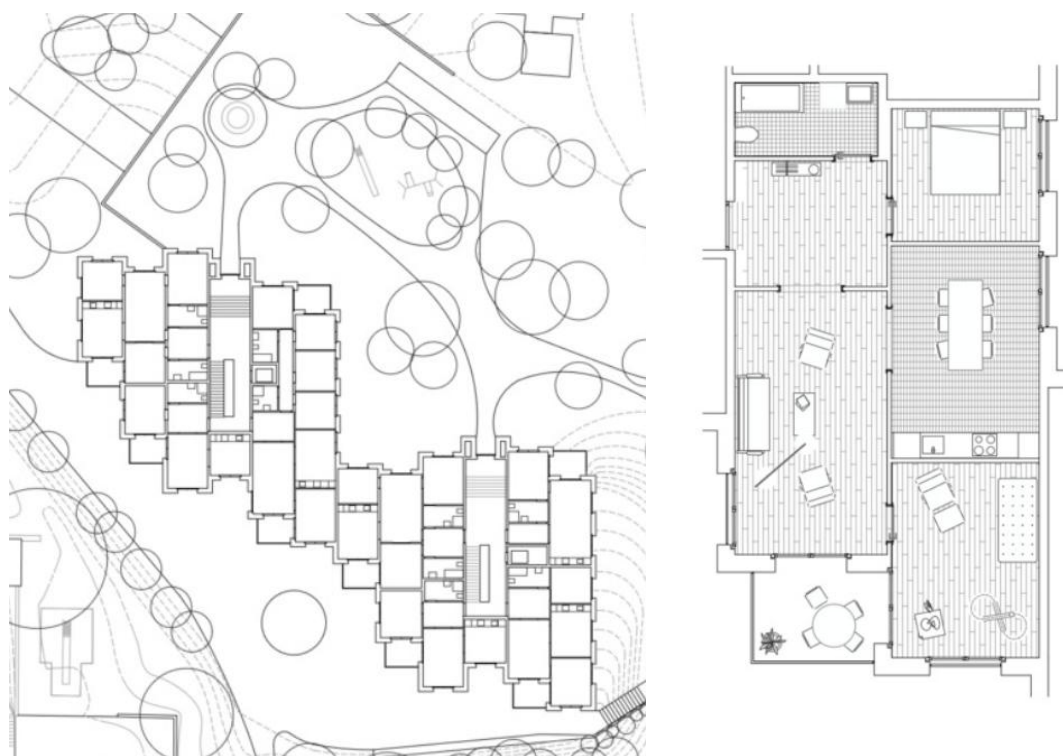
, 2.7. – Загальний план будинку та фото оточення. План однієї з квартир [9]
